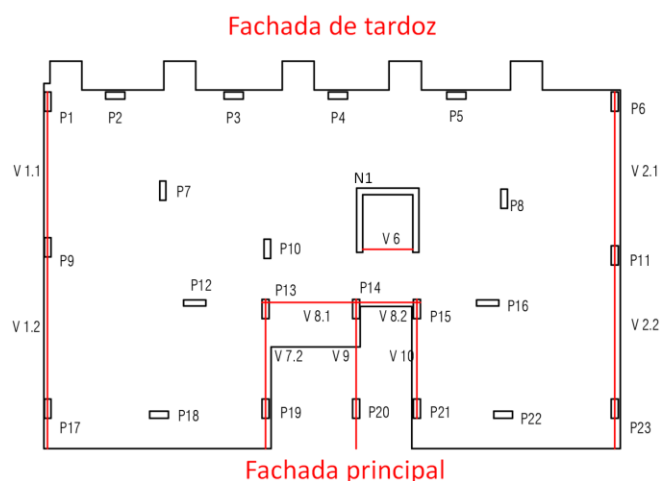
Planta da estrutura fornecida pela arquitetura. Identificação das fachadas e dos elementos estruturais.
